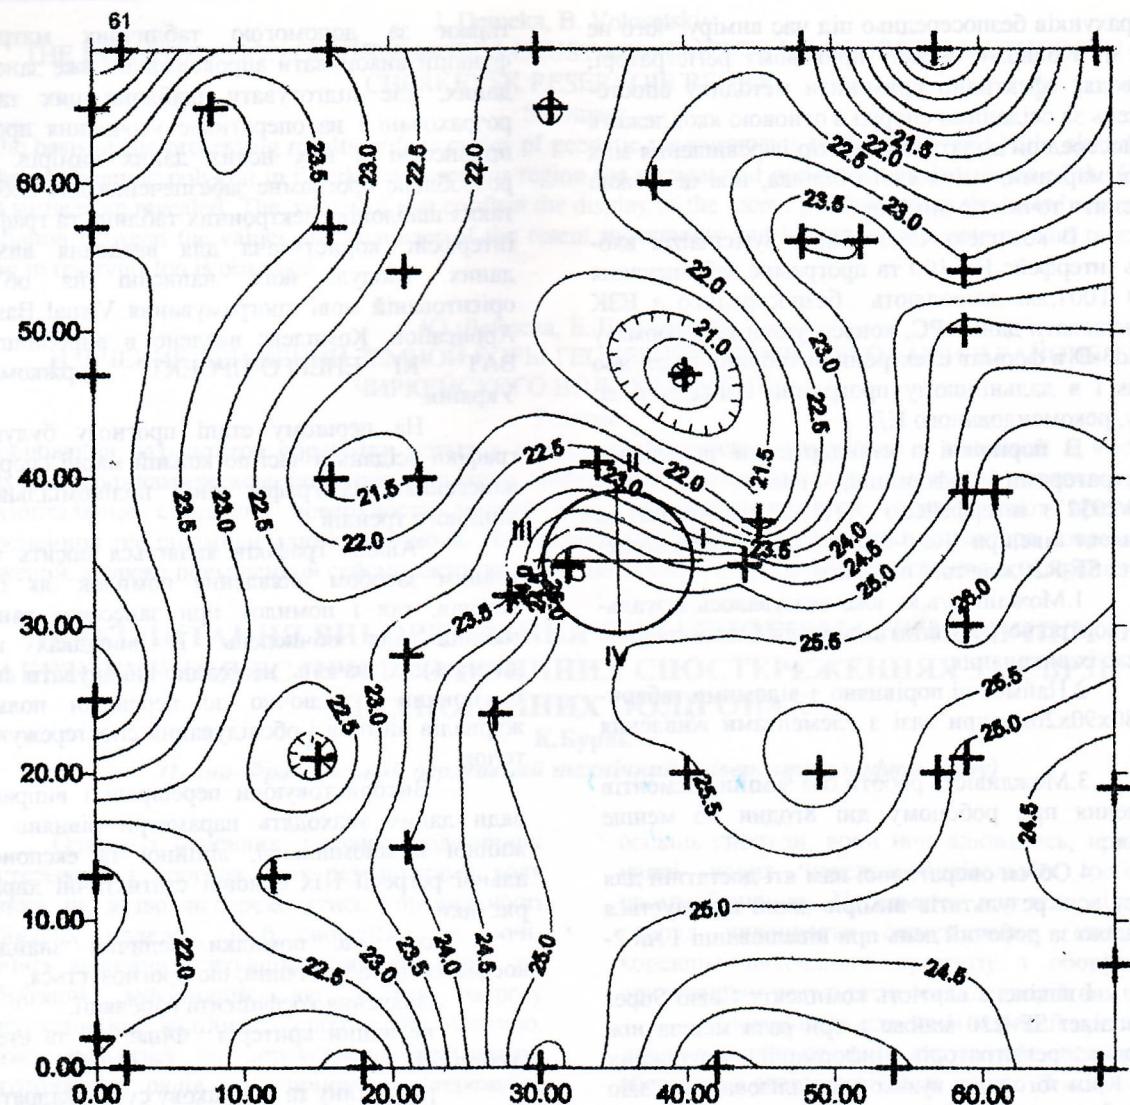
План фундаментної плити РВ з прогнозними ізолініями рівних осідань на 2001 р.
